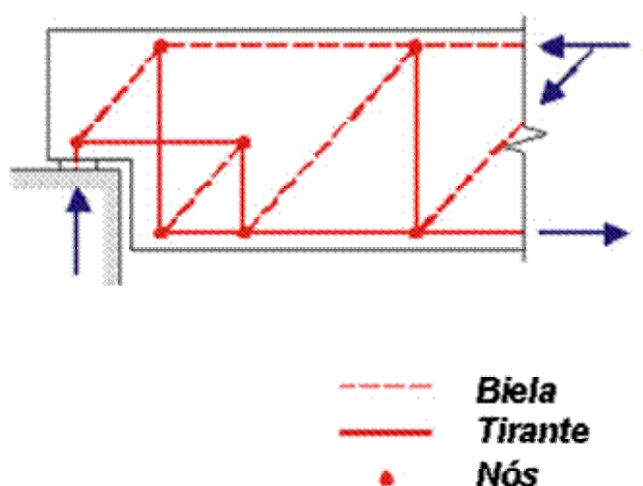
Modelo de bielas e tirantes aplicado a um apoio em dente de uma viga
